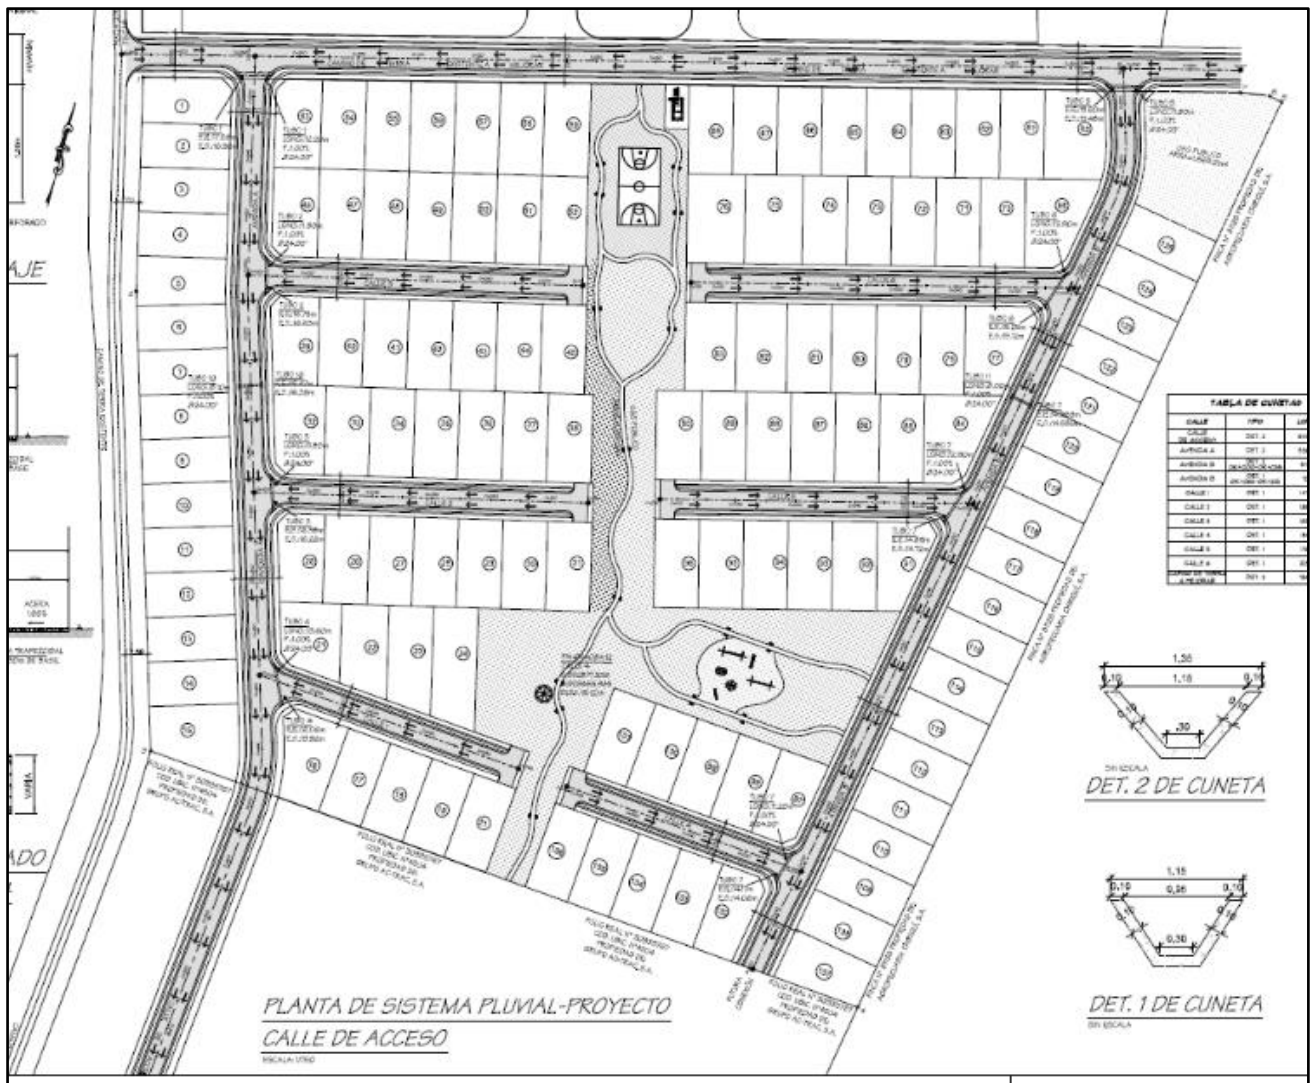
Fuente: detalle extraído de la hoja de plano 11 de 19 – Planta del Sistema Pluvial del Proyecto Residencial Santa Rita.
